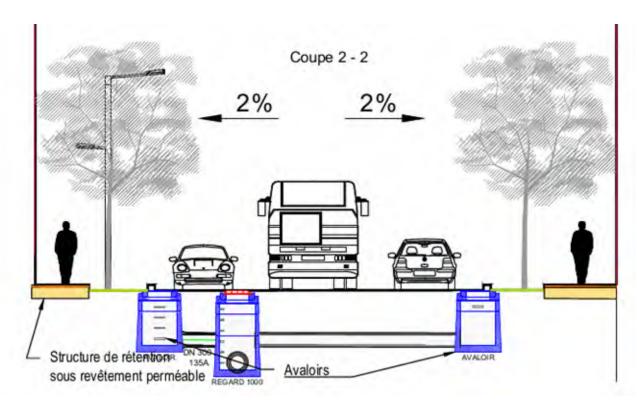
Coupe exemple de conservation du réseau pluvial existant
